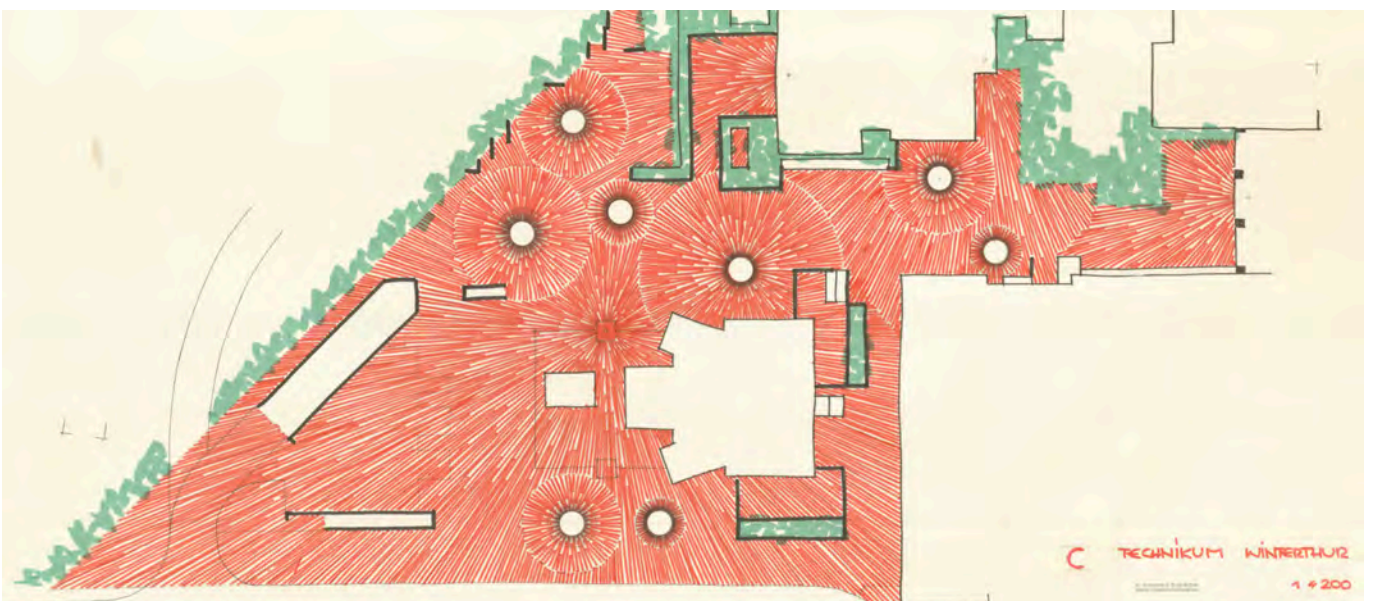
Vorplatz zur Technikumstrasse mit Hauptgebäude und Ostgebäude
